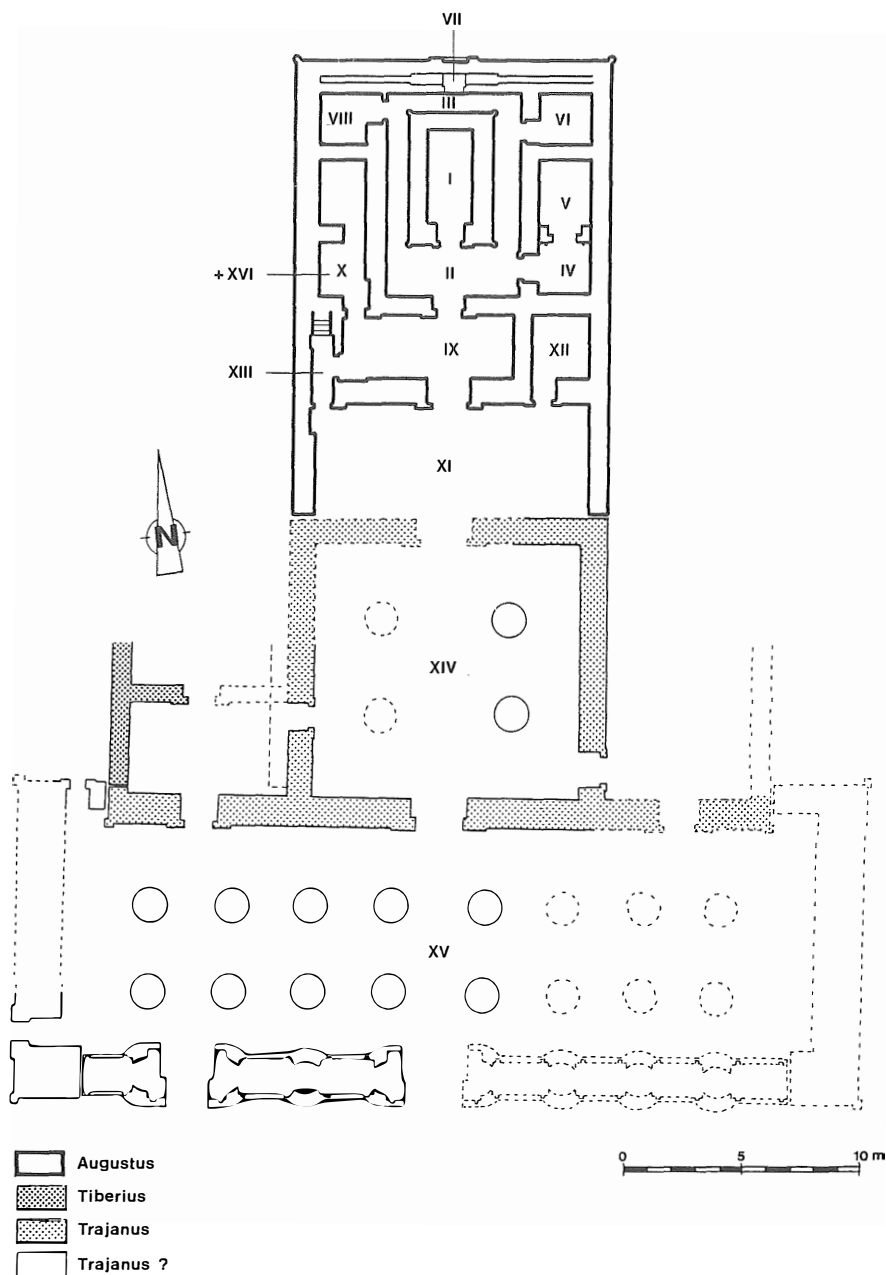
Plan van de tempel (E. Mahy, naar een plan van C. Traunecker).
